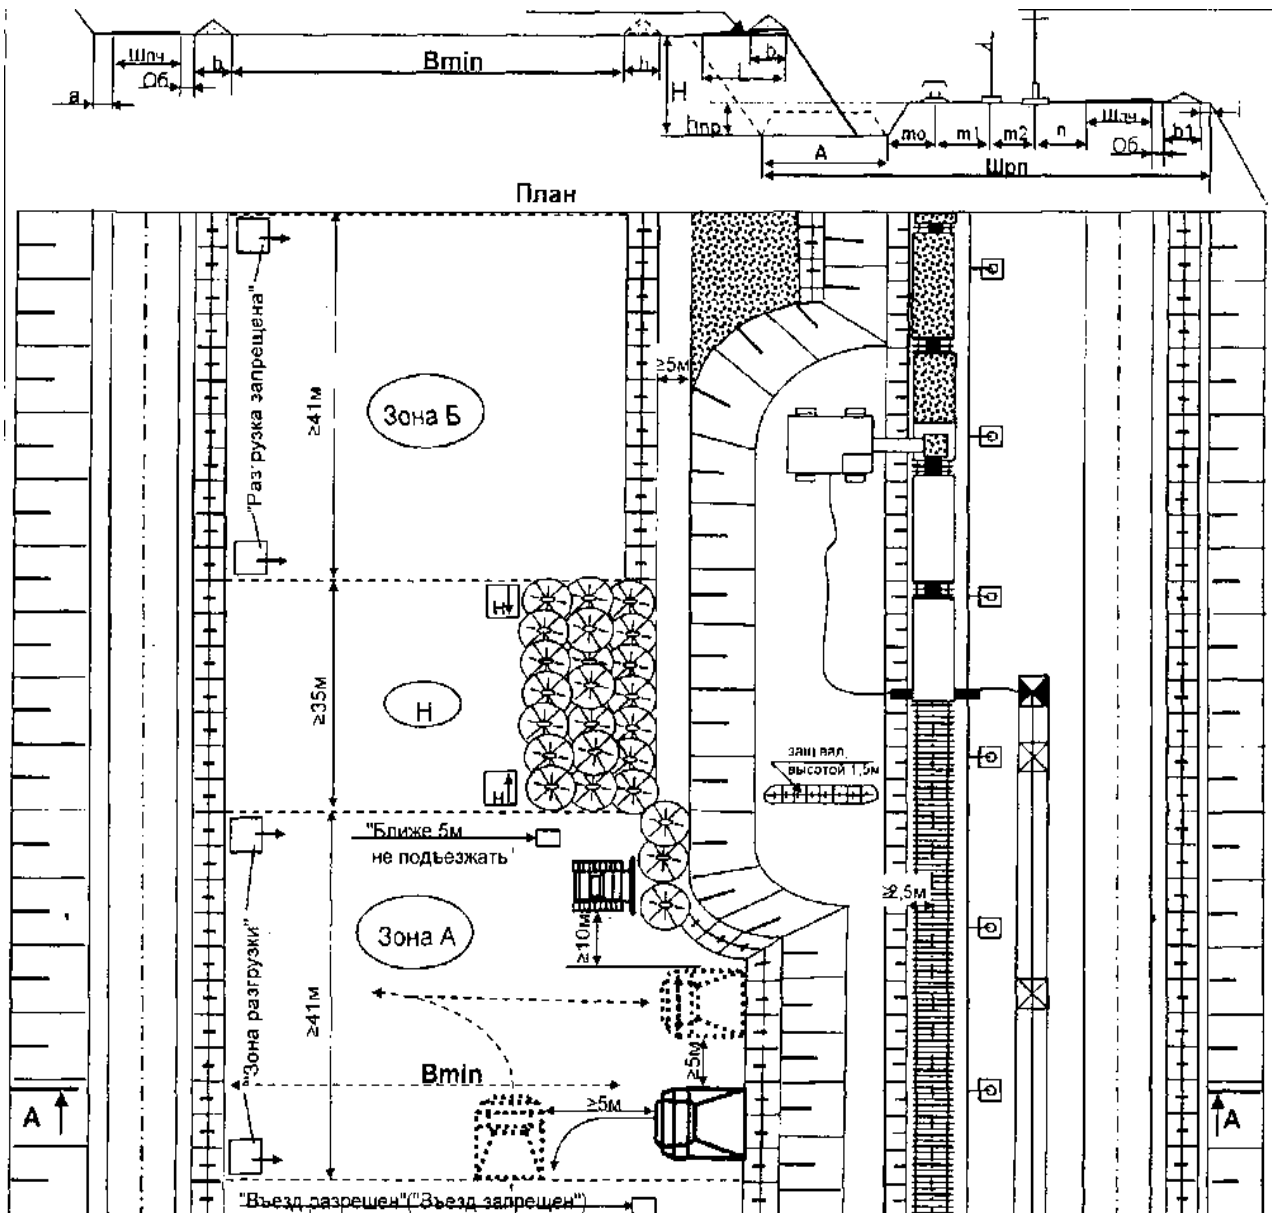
Перегрузочная площадка для перегрузки скальных пород из автомобильного в железнодорожный транспорт
